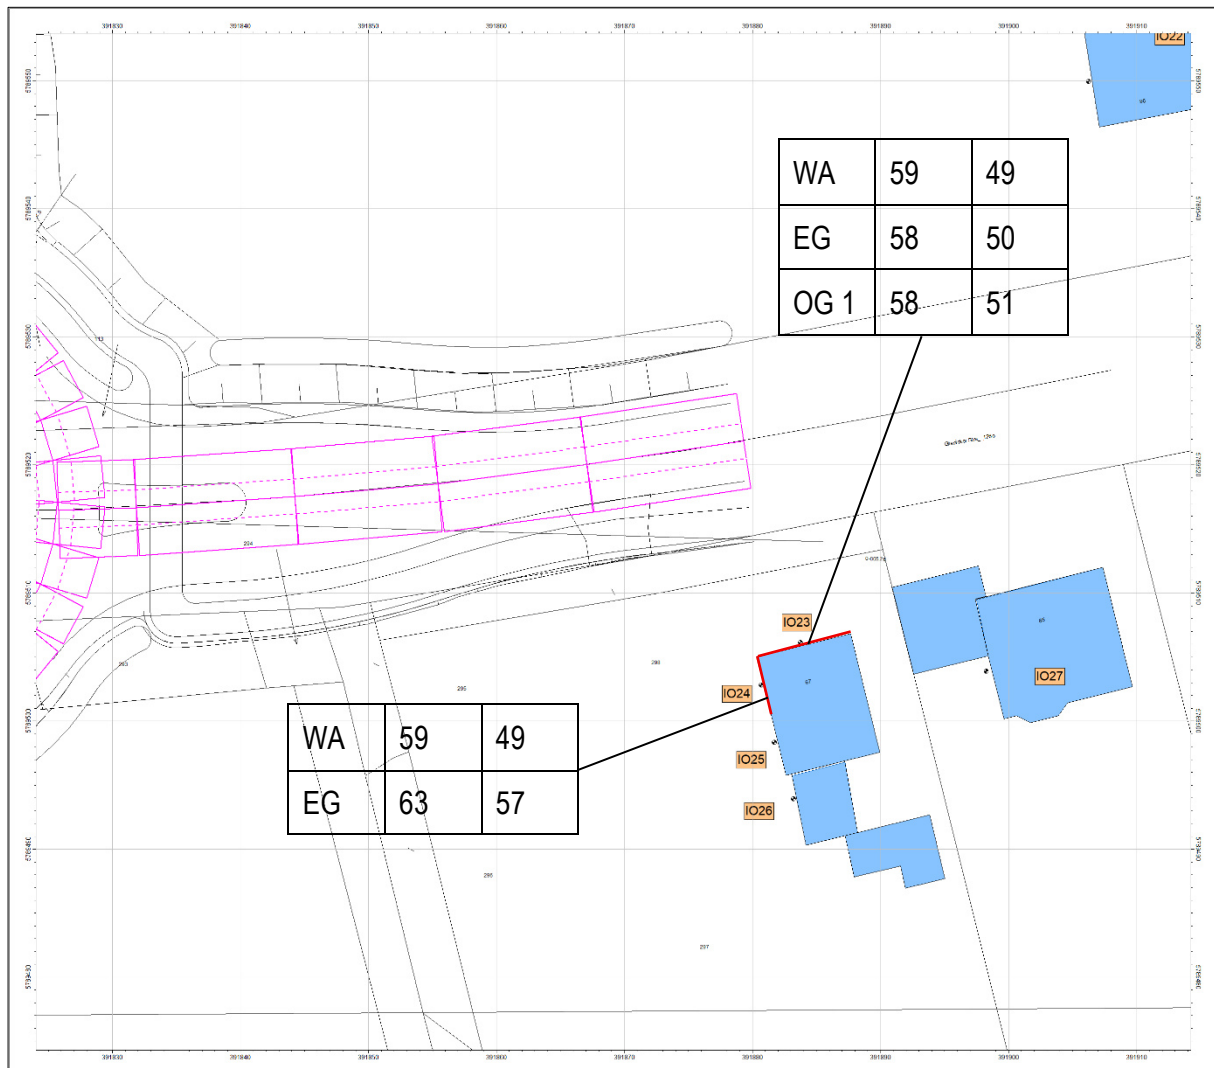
Lageplan Schallschutz- Umfahrung Abschnitt 1 (West) Glienicker Str. 67
